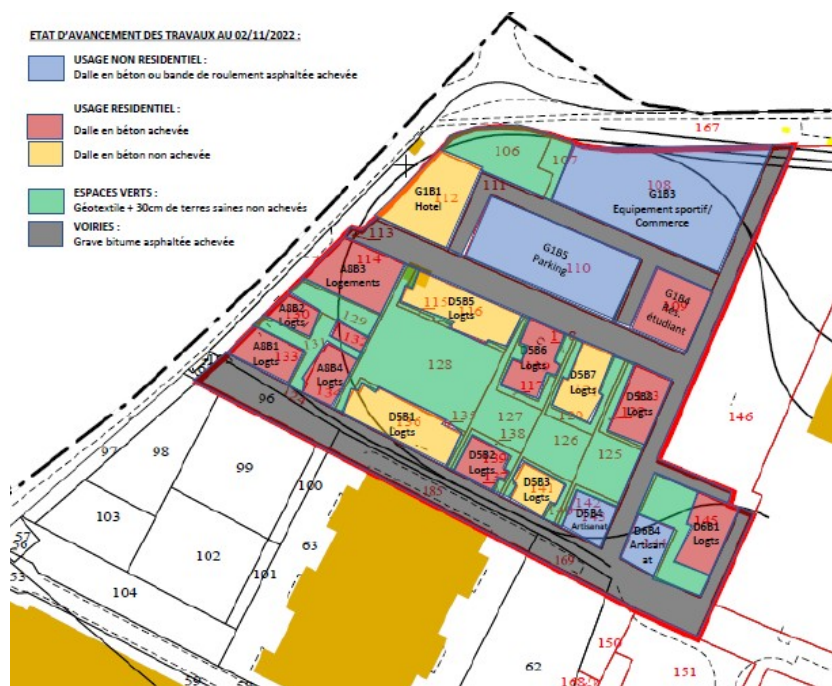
source : plan de synthèse - attestation travaux - studio brazza - Adim Nouvelle-Aquitaine - 02/11/2022
